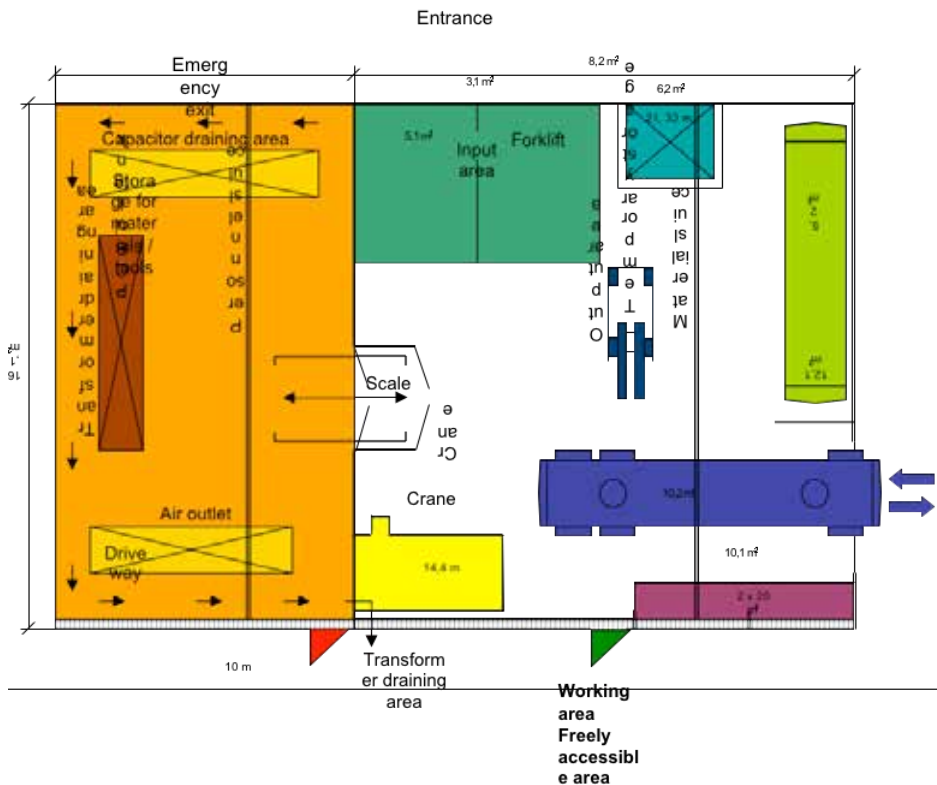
2e exemple d'une plateforme d'entreposage sûre
